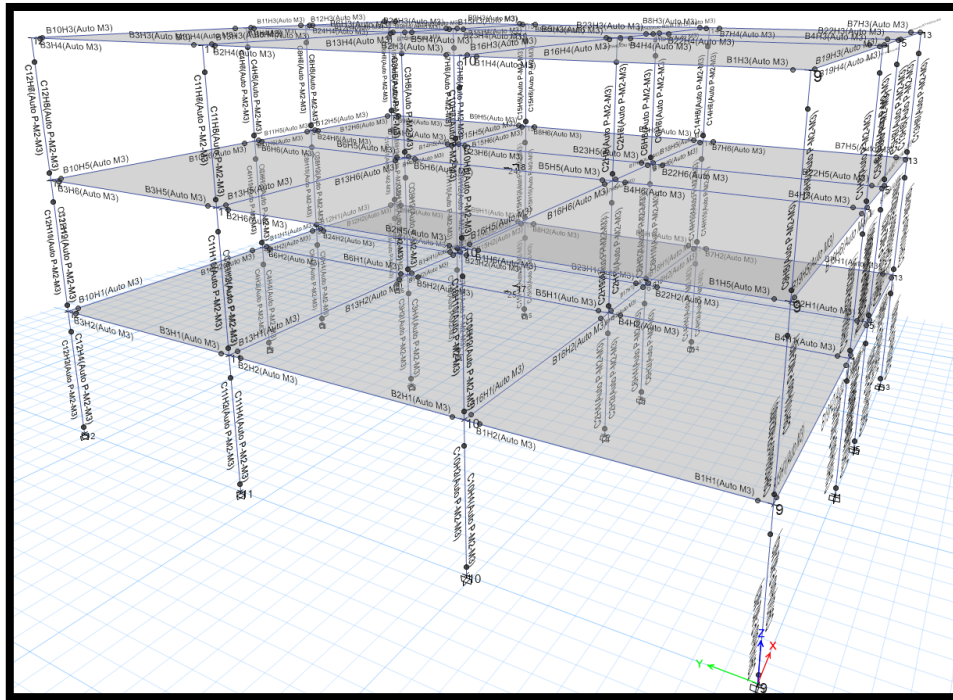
rotulas plásticas en columnas y vigas Módulo II.
